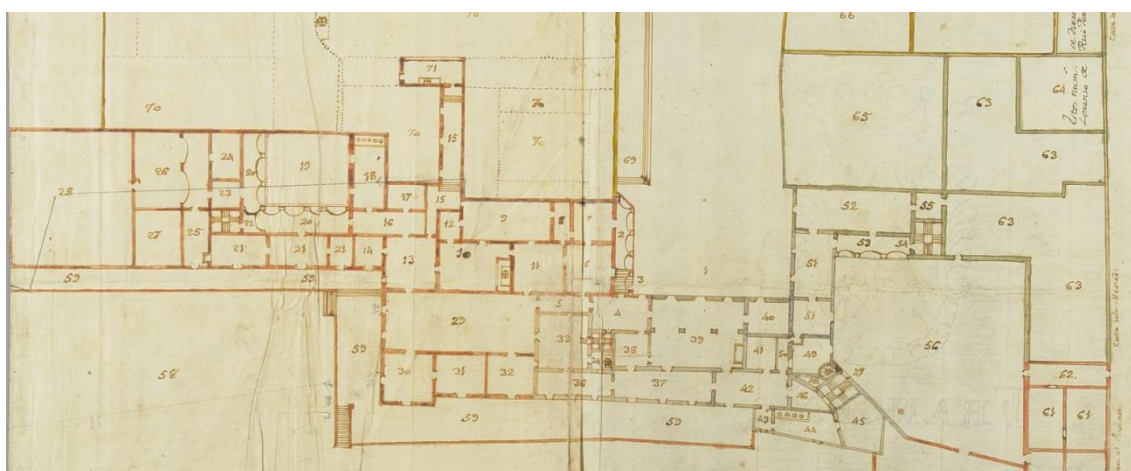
Velázquez Gaztelu, plano de 1762, detalle.
